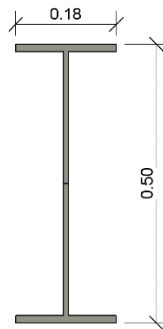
Sección de la viga BOYD compuesta por el perfil IPE 400.
